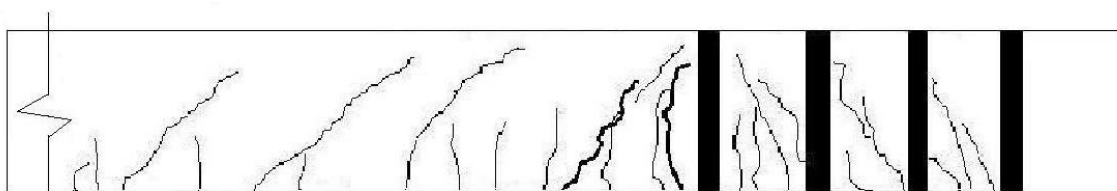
Panorama de fissuração da Viga V33.
